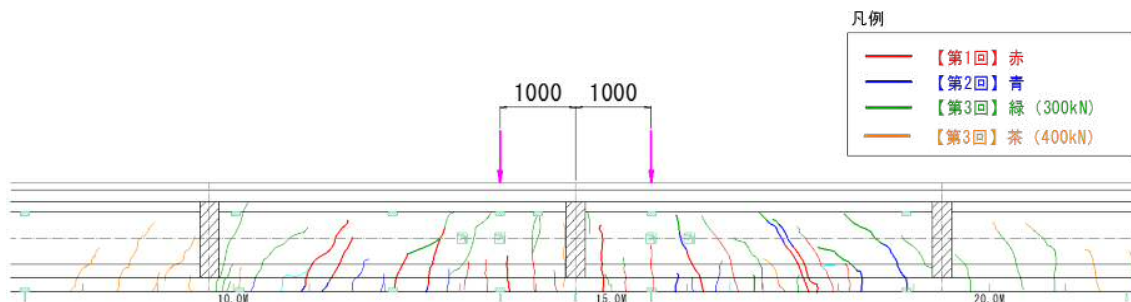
各載荷荷重状態でのひび割れ発生状況
